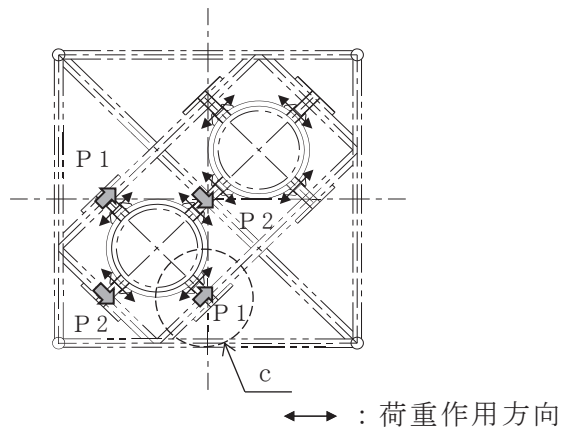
(2) 第2支持点部の平面図及び支持点荷重
